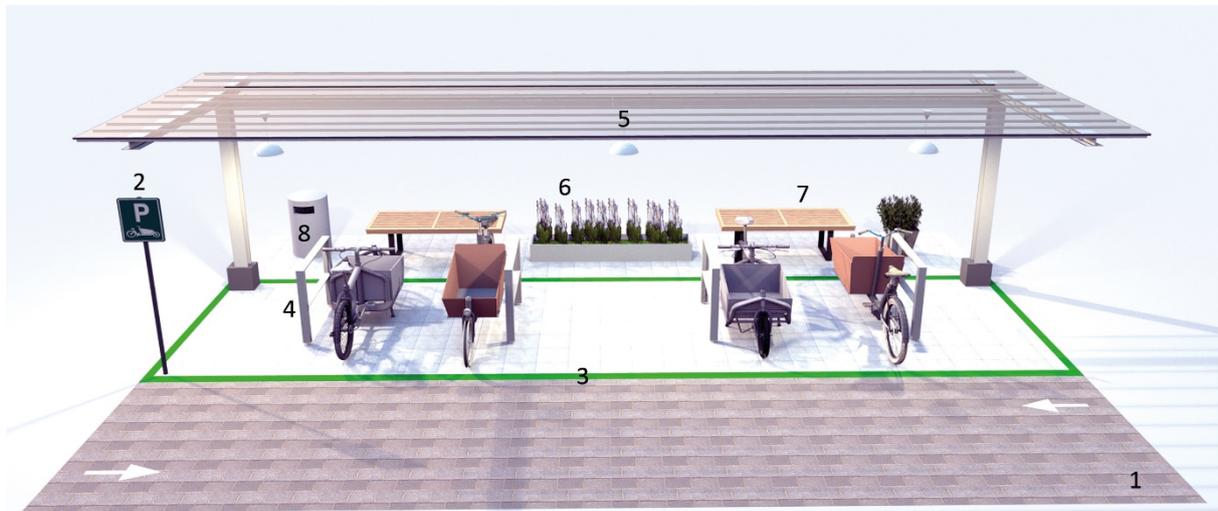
Grundrissdarstellung Variante 2: „Standardausstattung“; Quelle: eigene Darstellung
